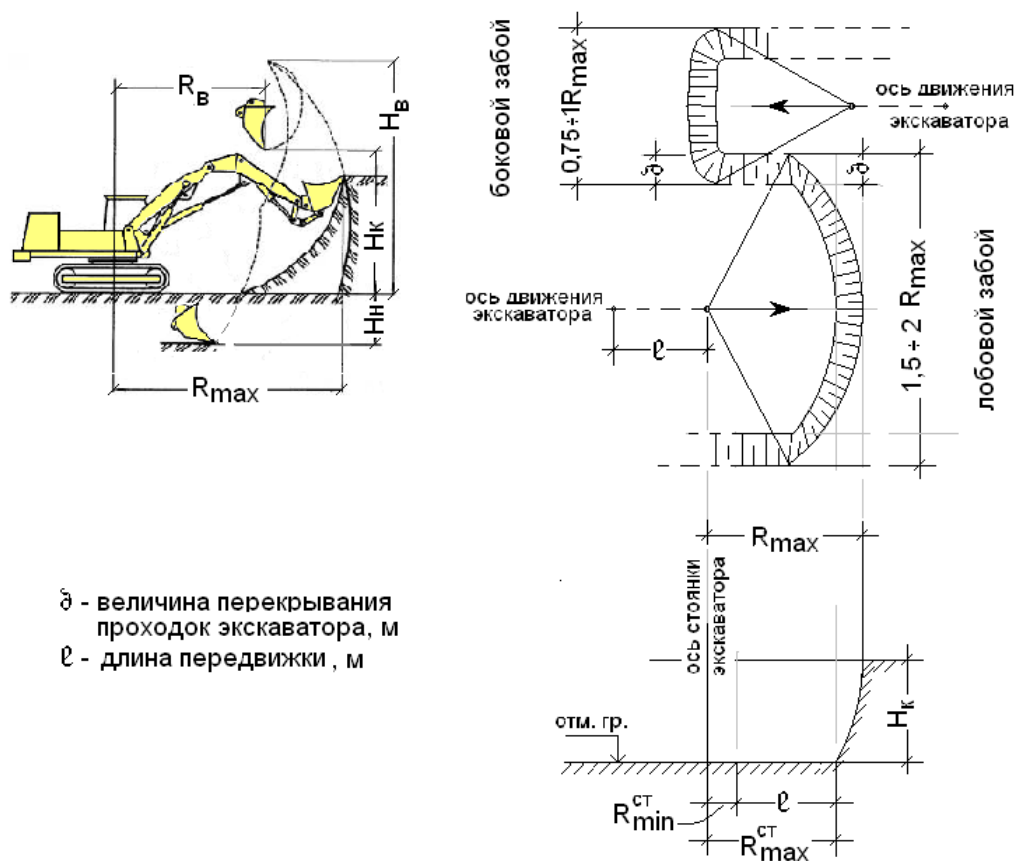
Схема разработки грунта экскаватором с оборудованием прямая лопата
